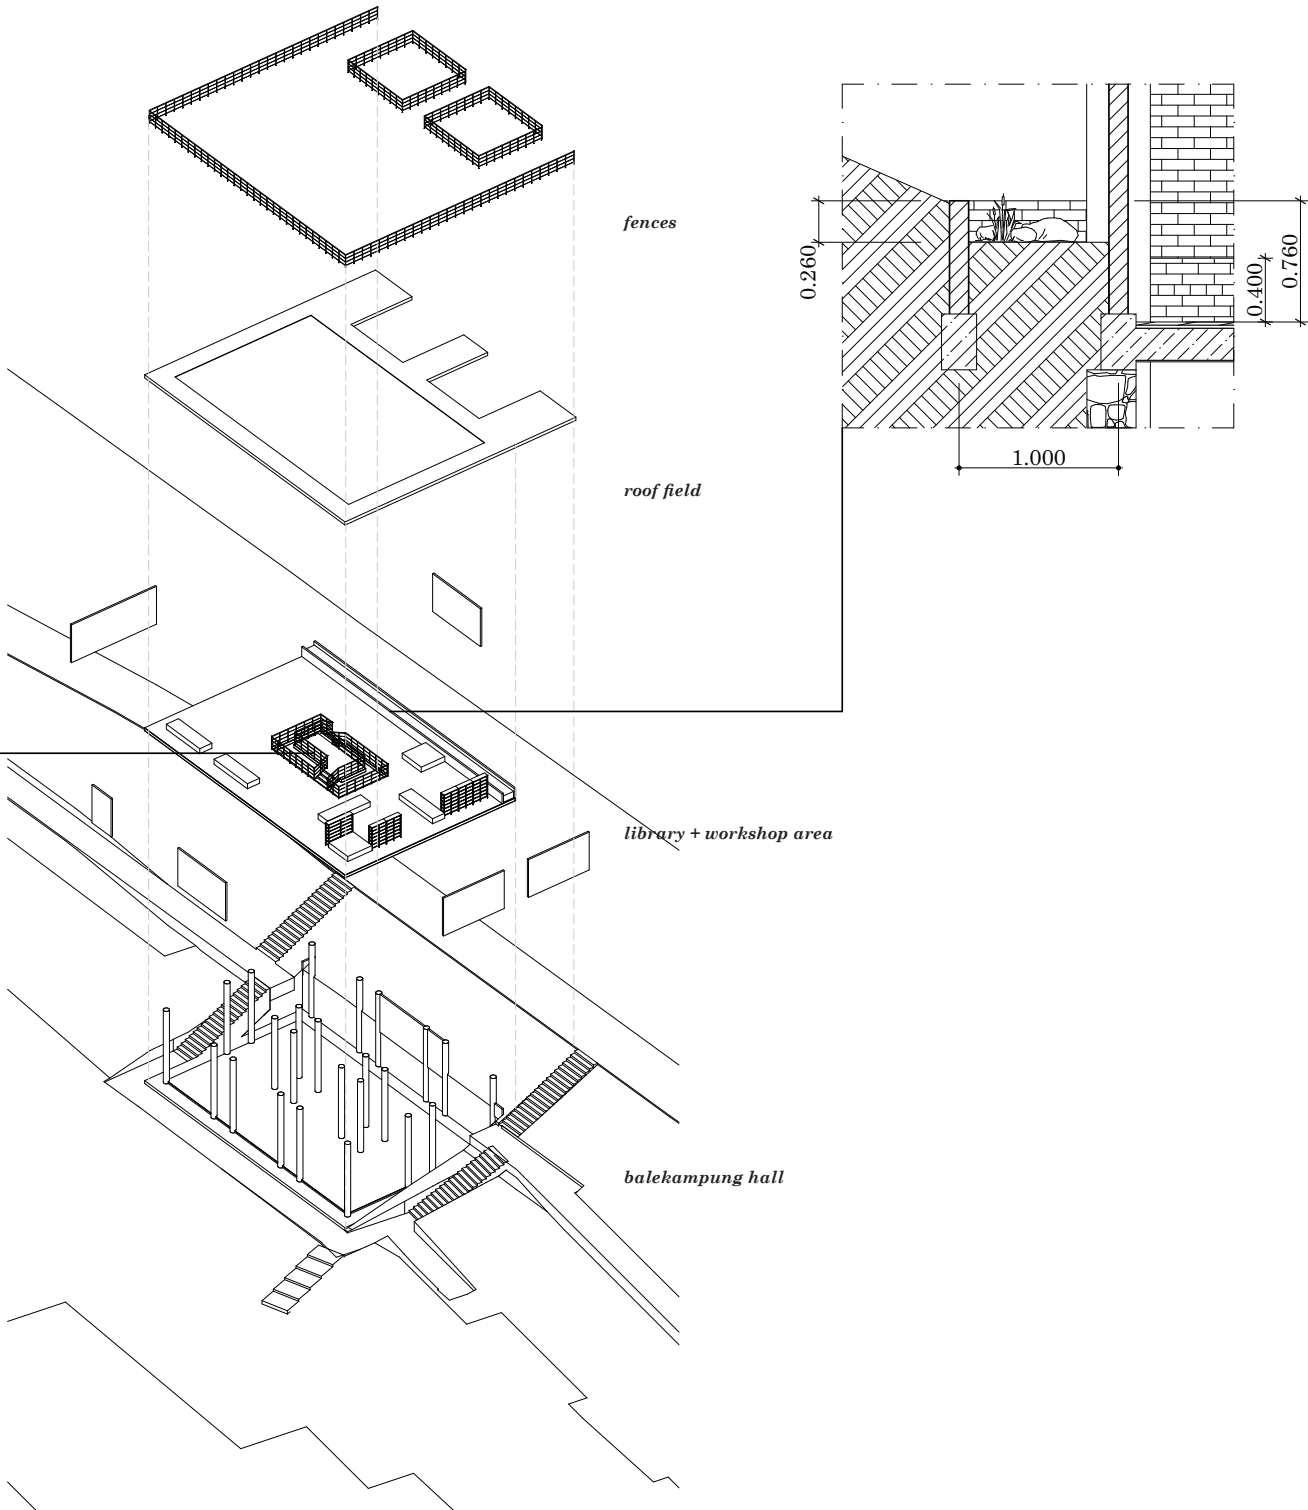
Skematik Tampak dan Potongan Balekampung
